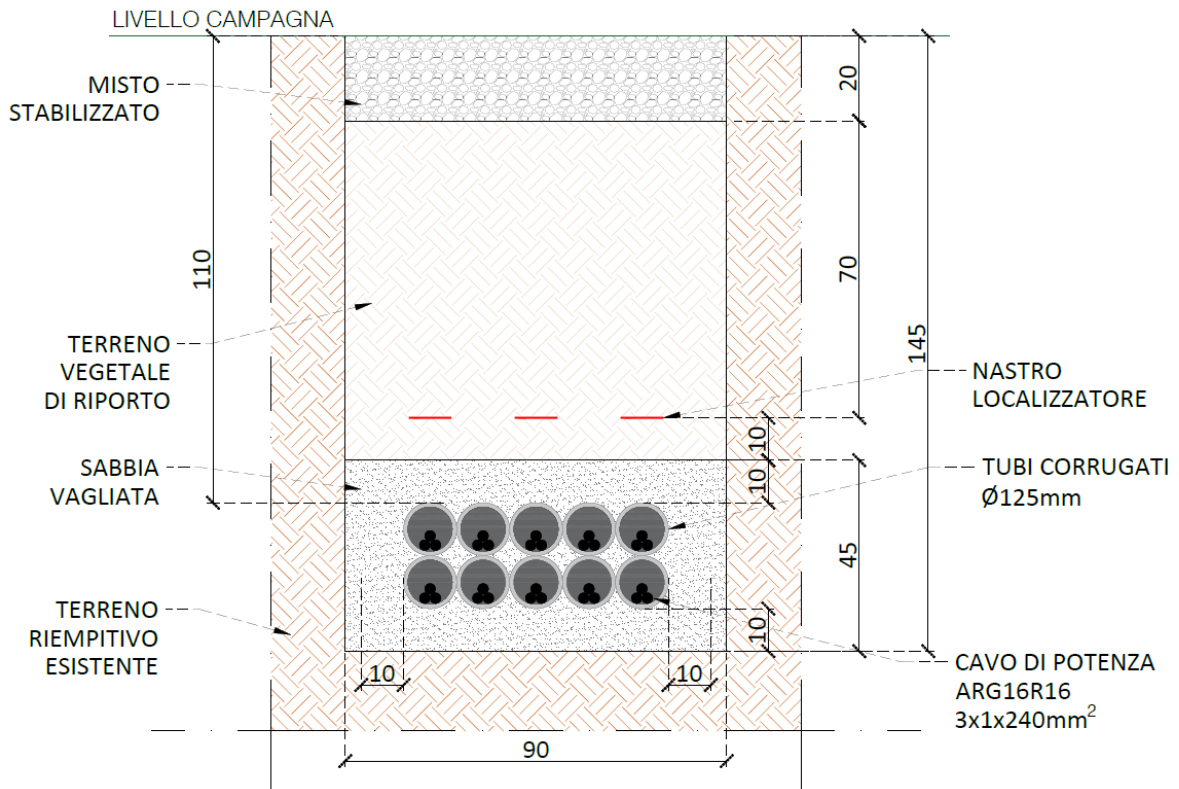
Sezione di scavo cavidotto BT 3x1x240 mm²
